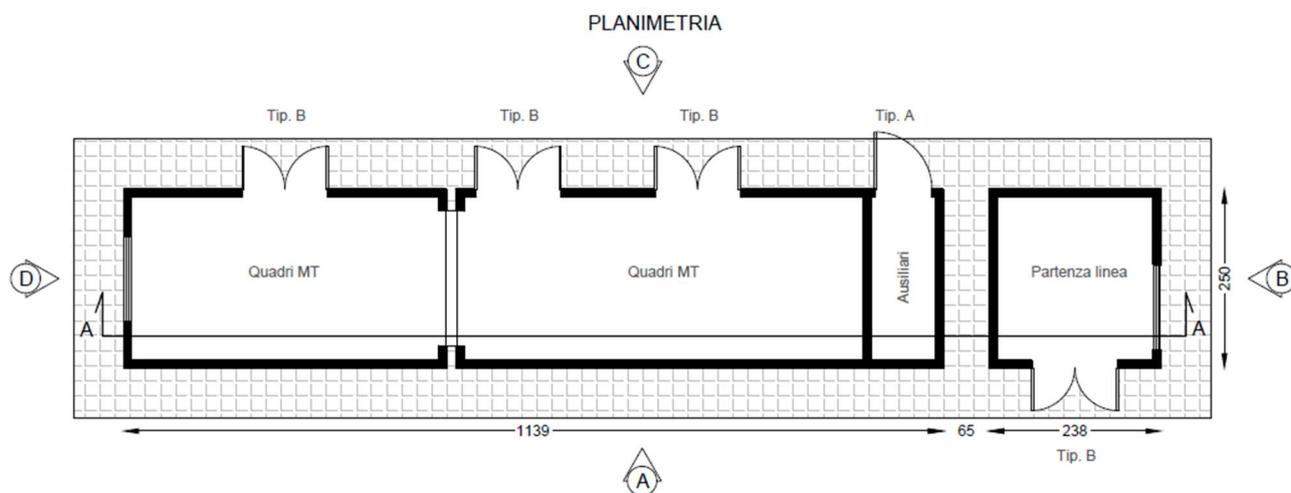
Planimetria generale della cabina MTR, misure in cm
